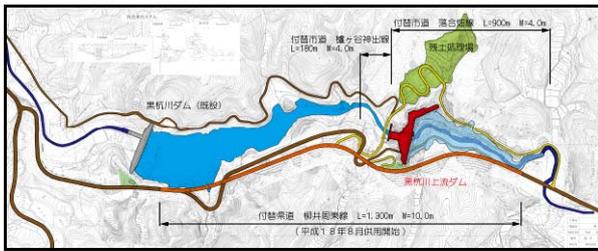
黒杭川ダム及び黒杭川上流ダム平面図
